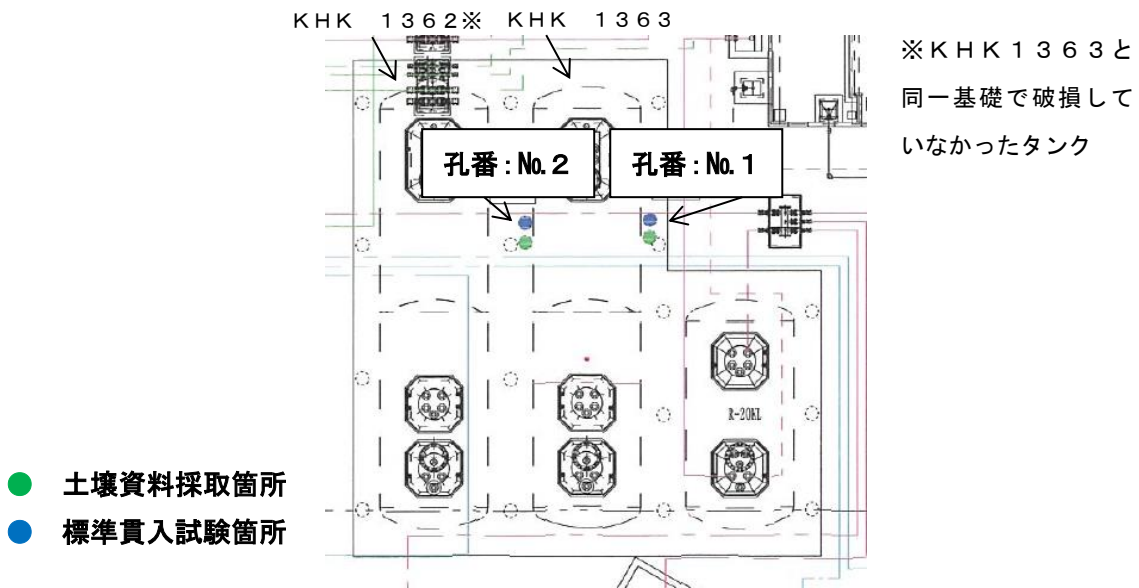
1. 1 ボーリング実施箇所平面図 (②)
